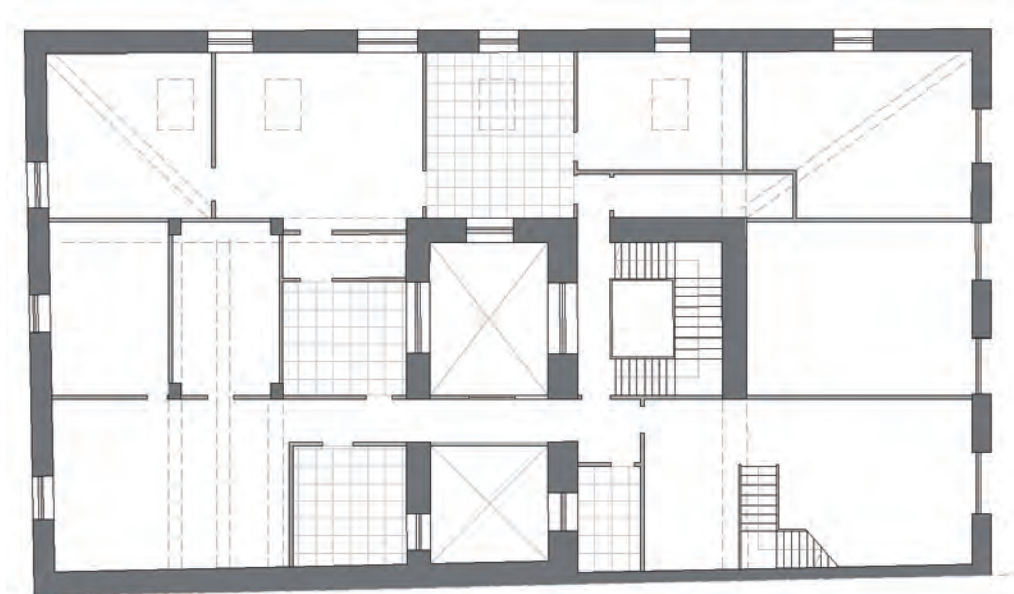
14. .TERCERA PLANTA BAJOCUBIERTA
